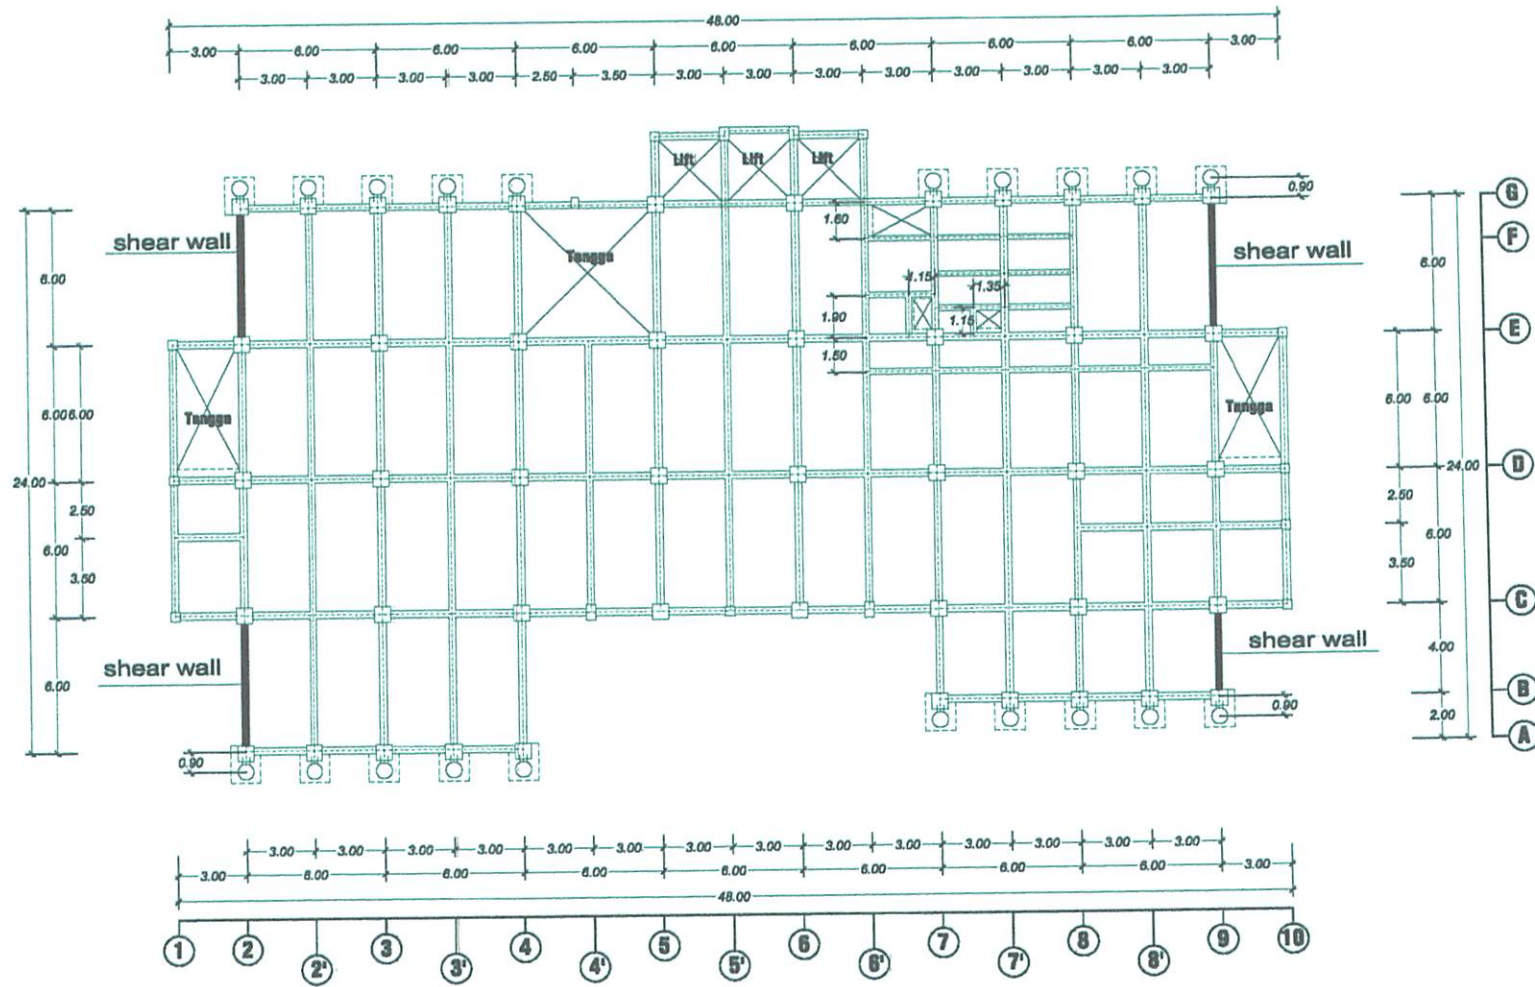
Denah Balok Dan Kolom Lt 6
